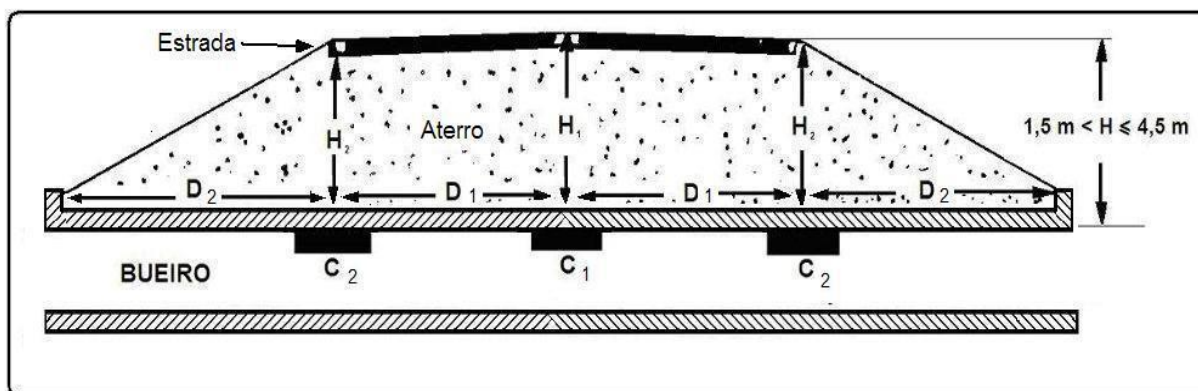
Perfil de bueiro com aterro de 1,5 m a 4,5 m
